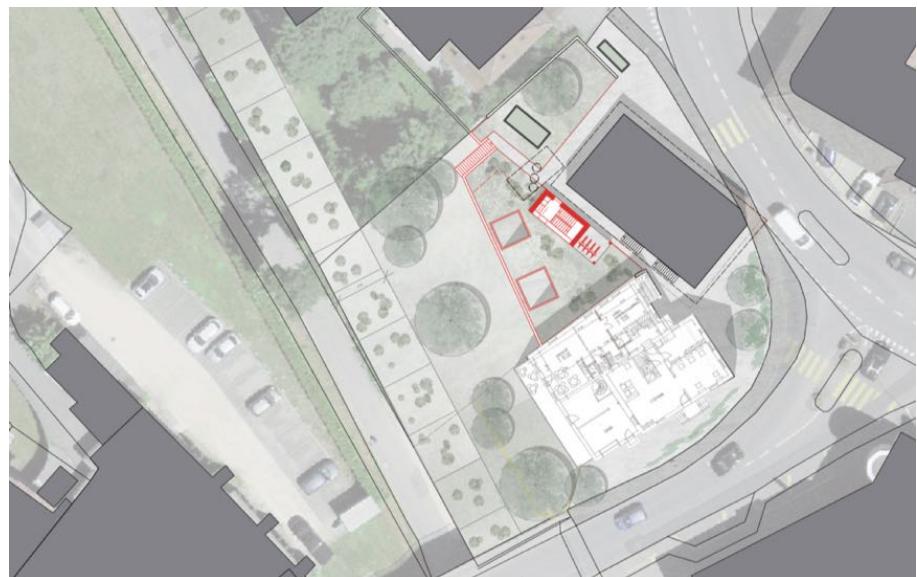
Aussenraumvariante mit Gärten und Bestockung im Stadtgraben
